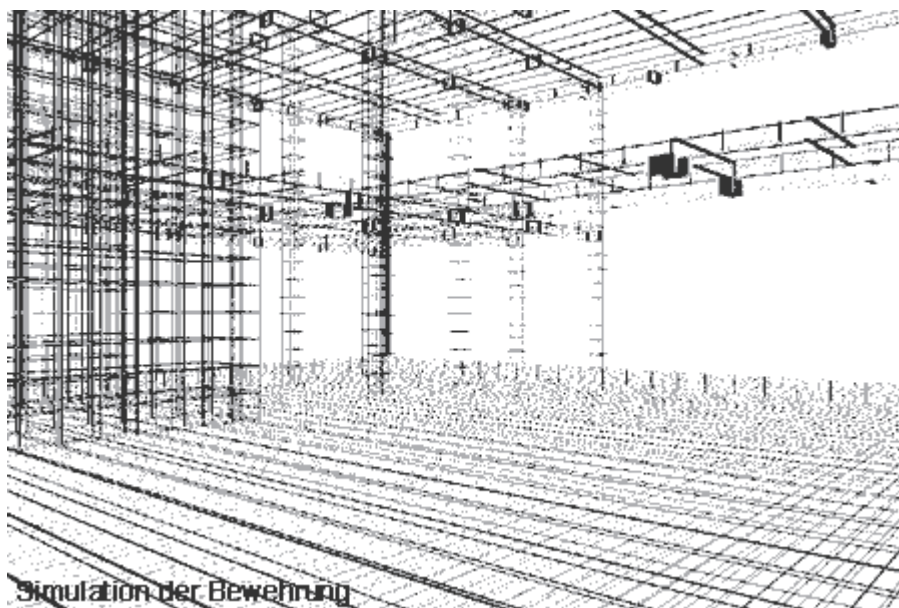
Bewehrung der Stahlbetonbauteile (Simulation)
